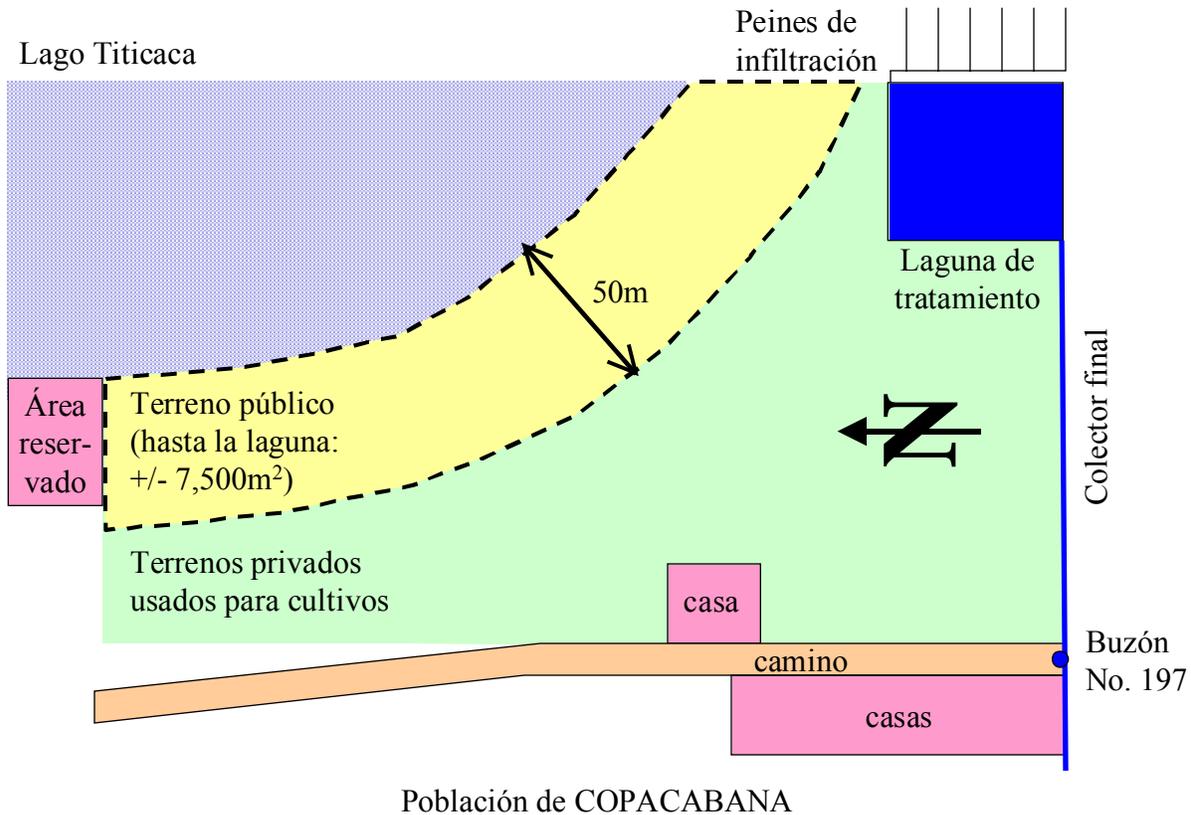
Esquema del área disponible para la planta piloto integrado al subsistema No. 2
